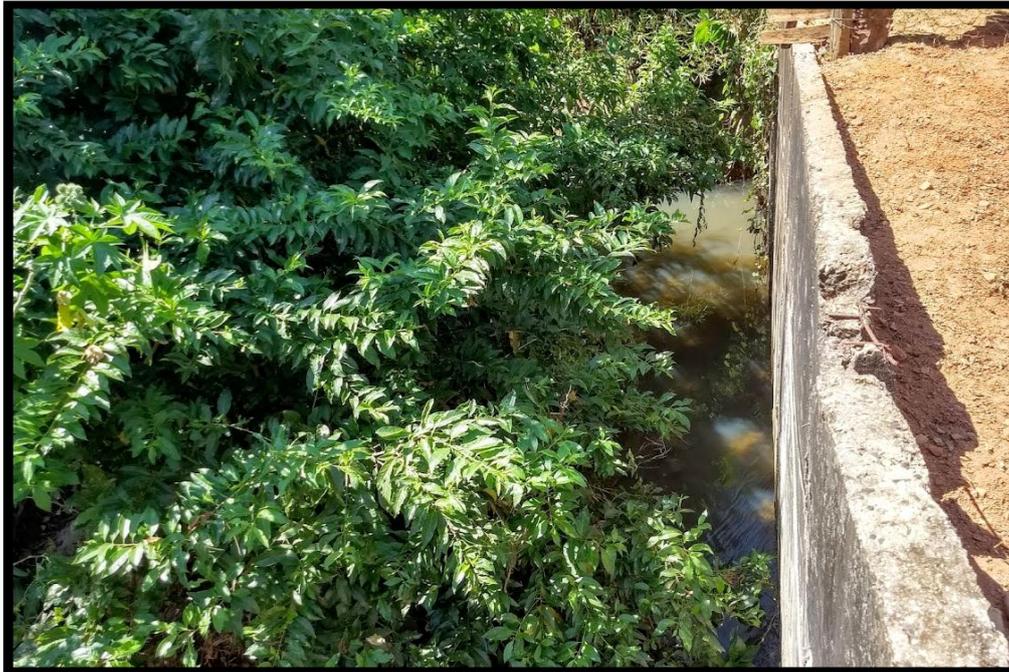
Córrego do Atalho – Trecho com edificações e com lixo
